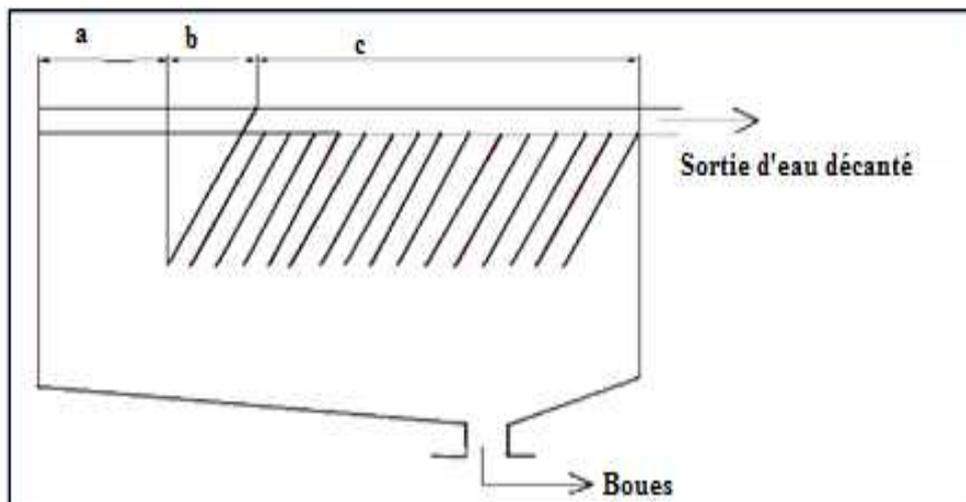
Les dimensions d'un décanteur lamellaire [13].
